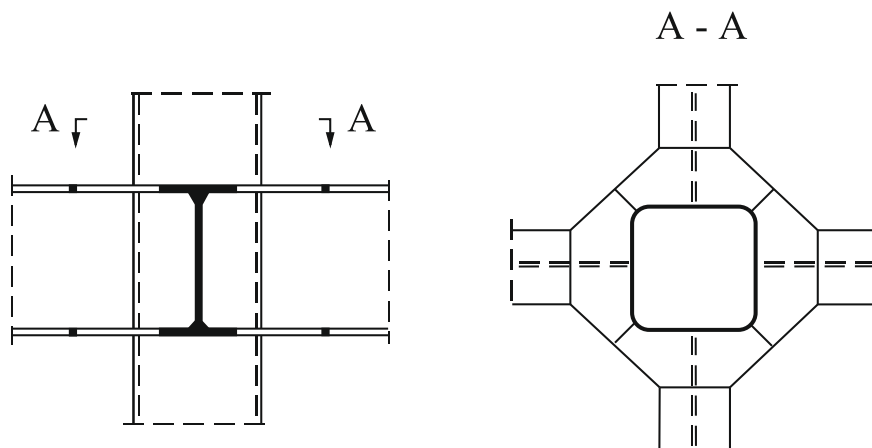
Сопряжение ригелей двутаврового сечения с трубобетонной колонной квадратного сечения [4]
